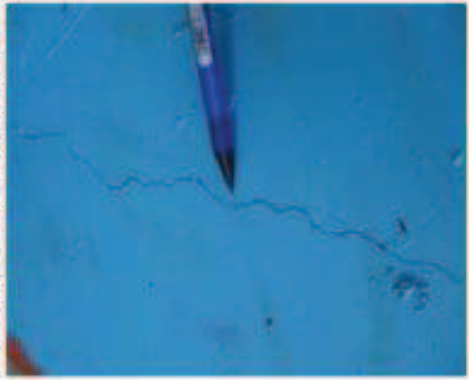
Oculares en la zona norte del tubo de la pista 25.
